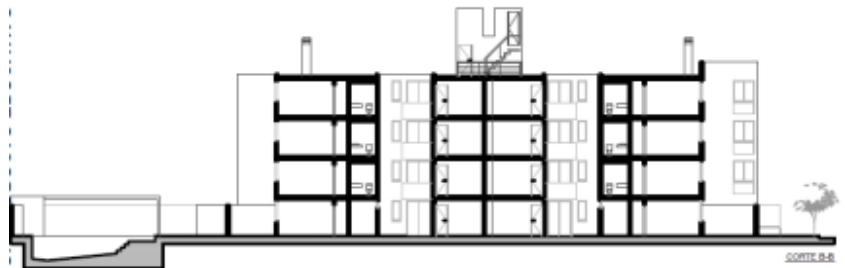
Edificio Analizado. Fachada y Corte Longitudinal
